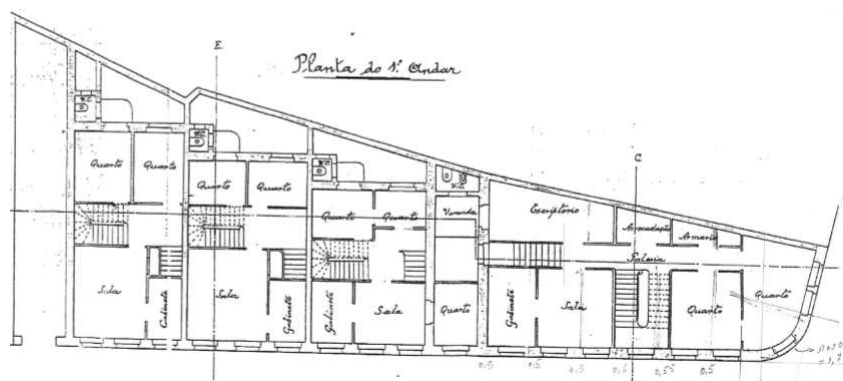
Planta do 1º Andar; Primeiras plantas da construção datadas do final do século XVIII
